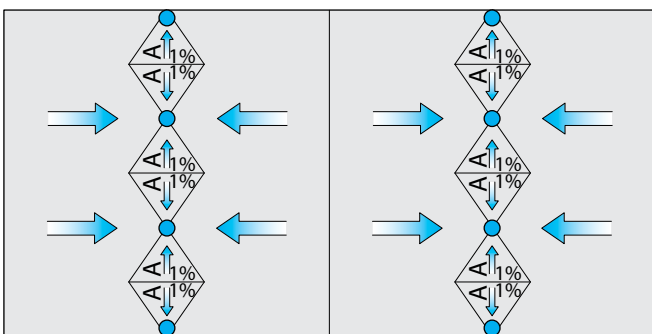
Jeweils ein zweiseitiges Gefälle von 1,5% zu den Dachwassereinläufen, z.B. bei Metall- oder Holzunterkonstruktionen, mit einer aufgesetzten Gefälledämmung (A) zwischen den Einläufen. Dachwassereinläufe an die sanitären Entwässerungsleitungen angeschlossen.
